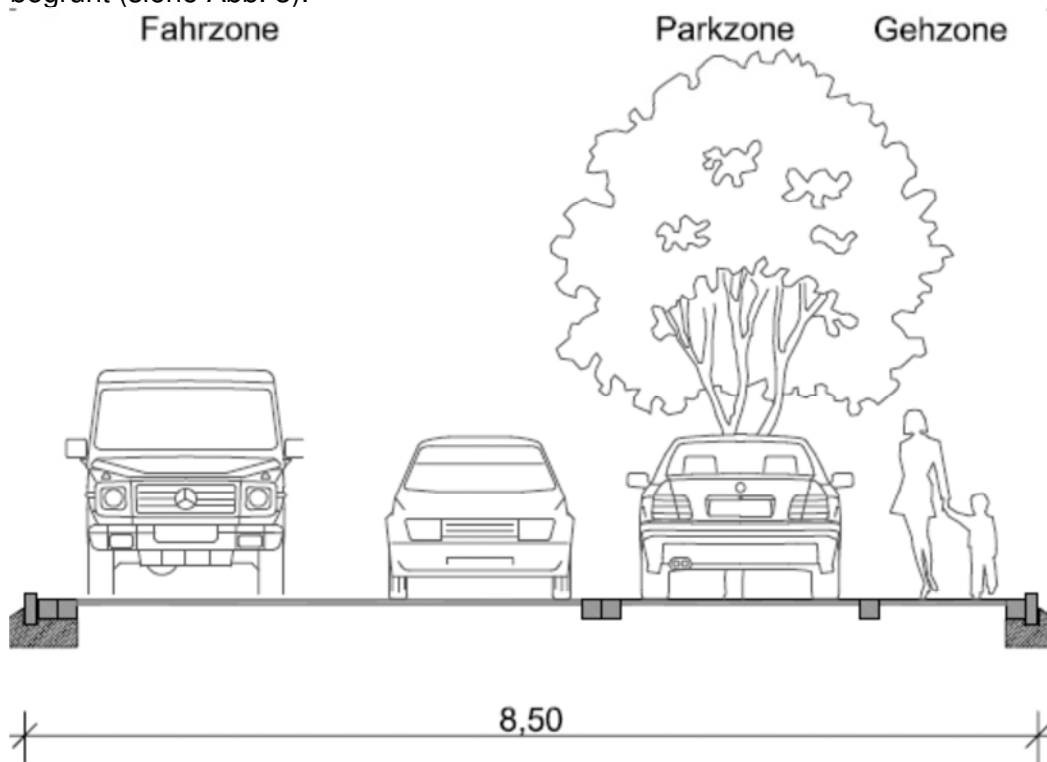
Querschnitt nordwestliche und südöstliche Erschließungsstraße (Planstraße A)
